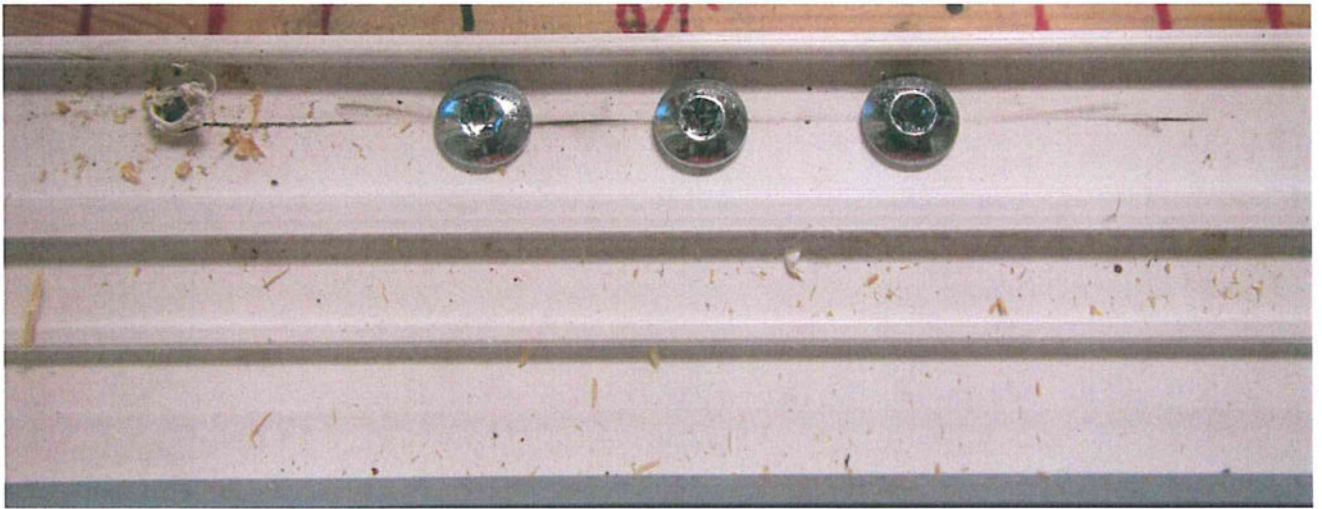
Ansicht auf die Verschraubung im Rahmenprofil. Die blaugelb Rahmenfixschrauben werden nicht durch die Stahlarmierung geschraubt
